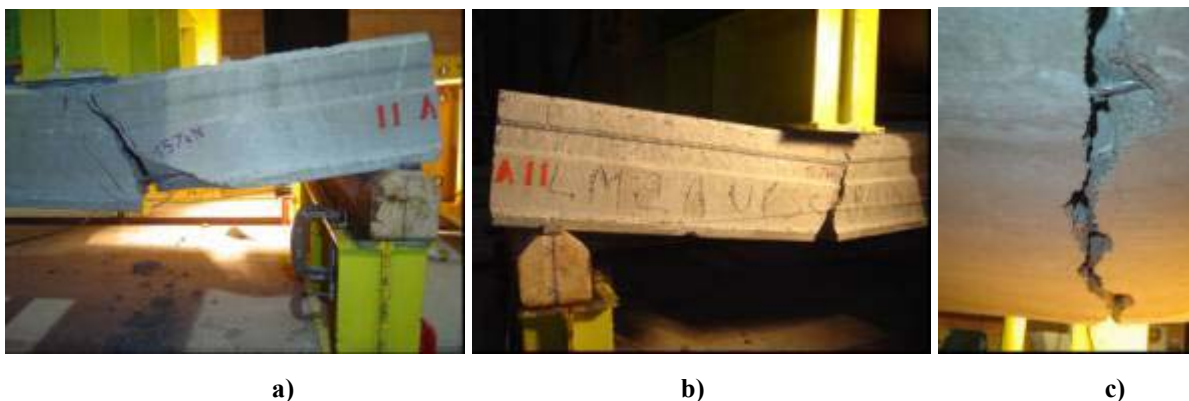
Abertura de fissura da laje L11-20-SC-7_C: a) Vista lateral - lado esquerdo; b) Vista lateral - lado direito; c) Vista inferior da laje.
